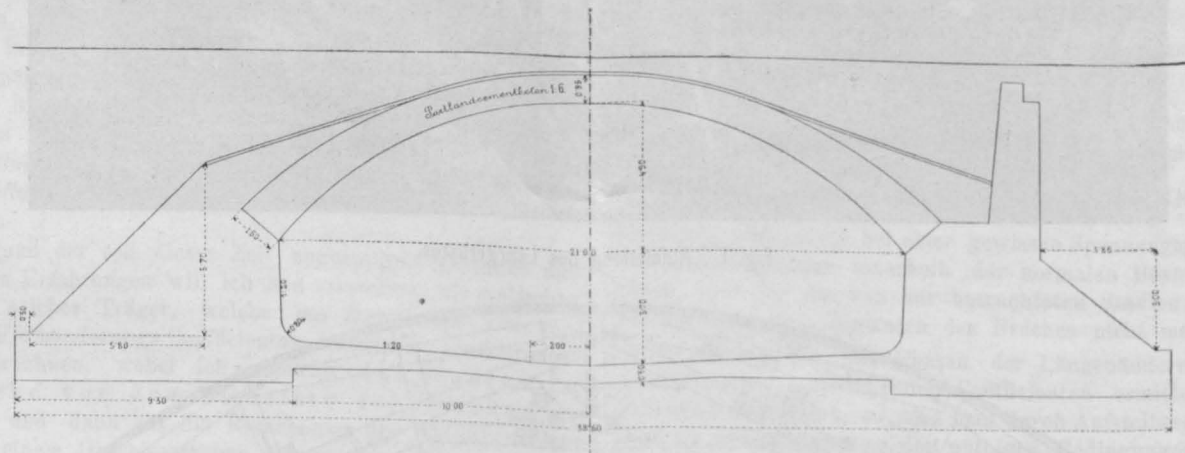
Einwölbungsprofil mit Stampfbeton.
